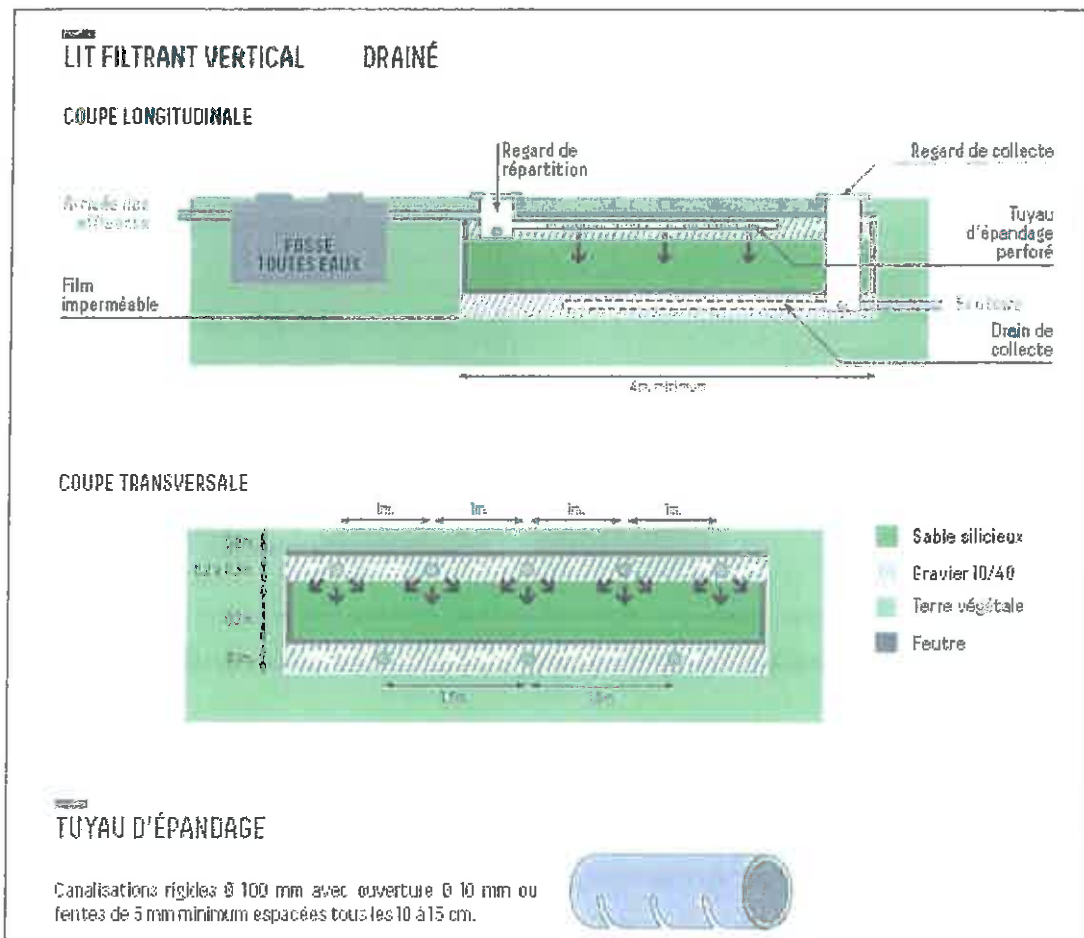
Exemple d'une filière d'assainissement non-collectif avec filtre vertical drainé
